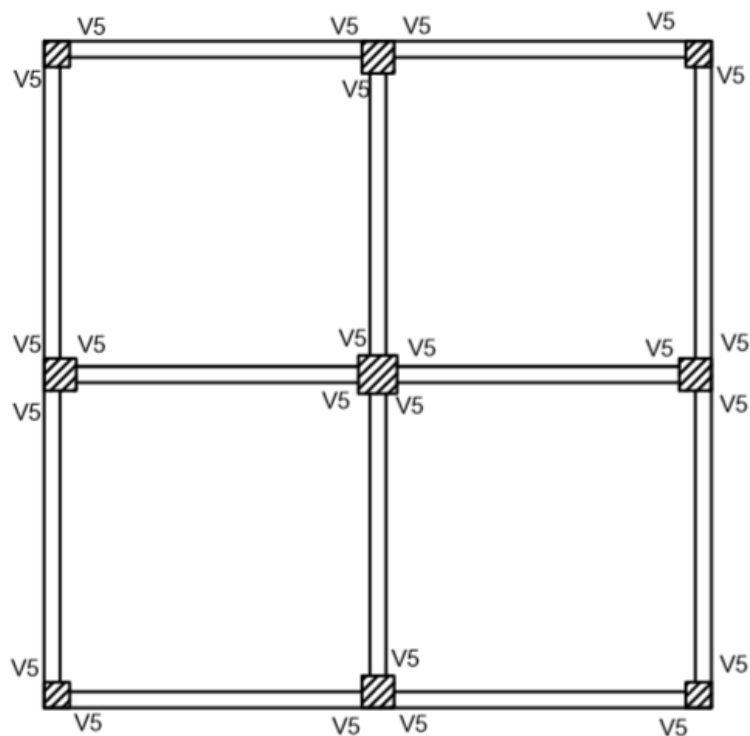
Planta do terceiro piso do Edifício 1.
